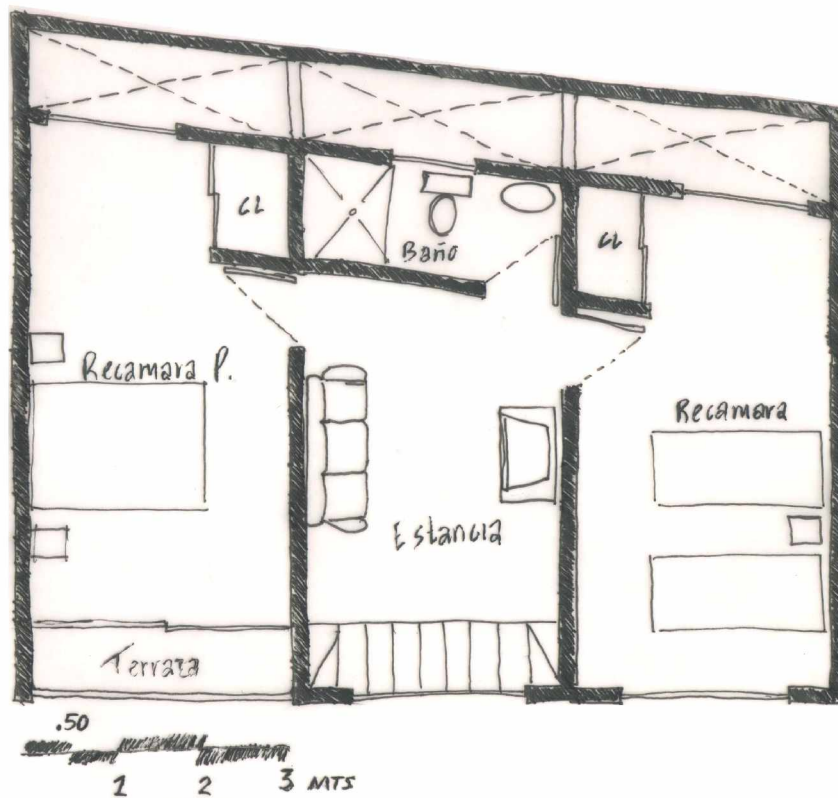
BOCETO DE VIVIENDA 3 CUARTOS PLANTA ALTA
